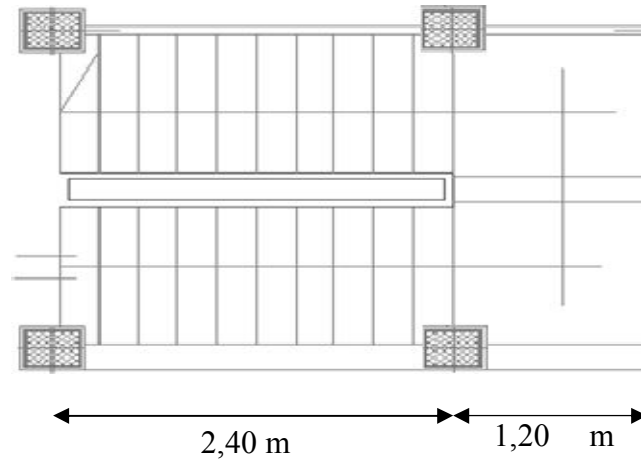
Vus en plan de l'escalier (type 1)
